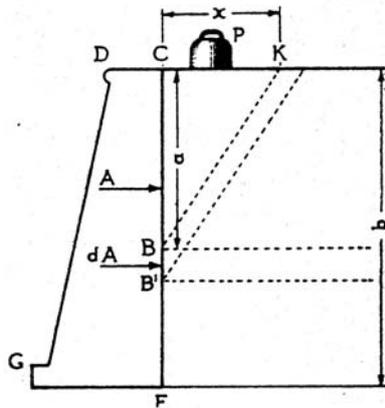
Esquema utilizado por Coulomb (1773) para derivar su fórmula de empujes sobre muros
